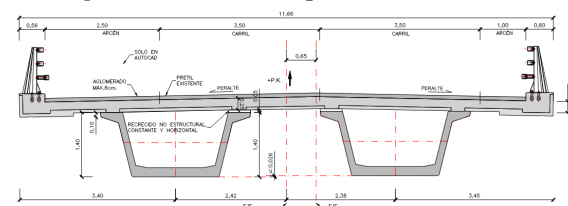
Nueva sección transversal de los vanos 7, 8 y 9 del viaducto de Ruitelán
